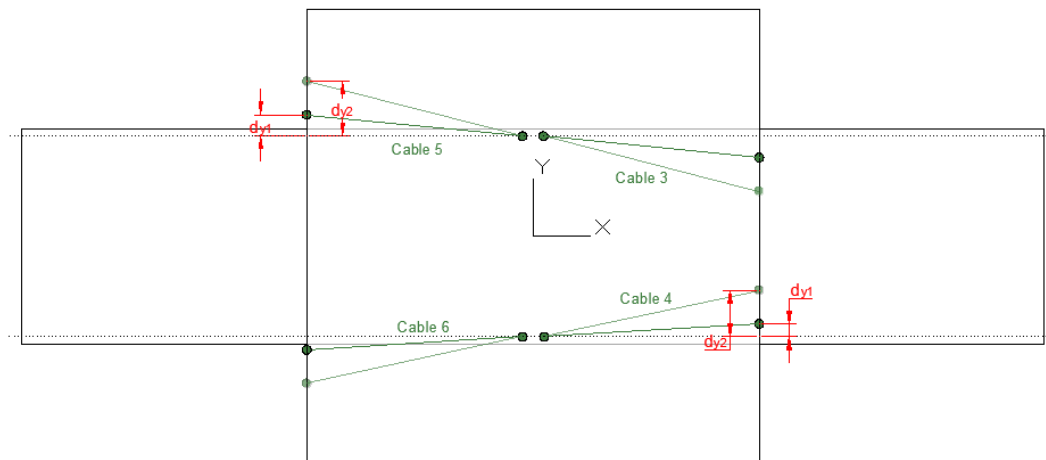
Vista en planta del sistema para aclaración del parámetro d_y
